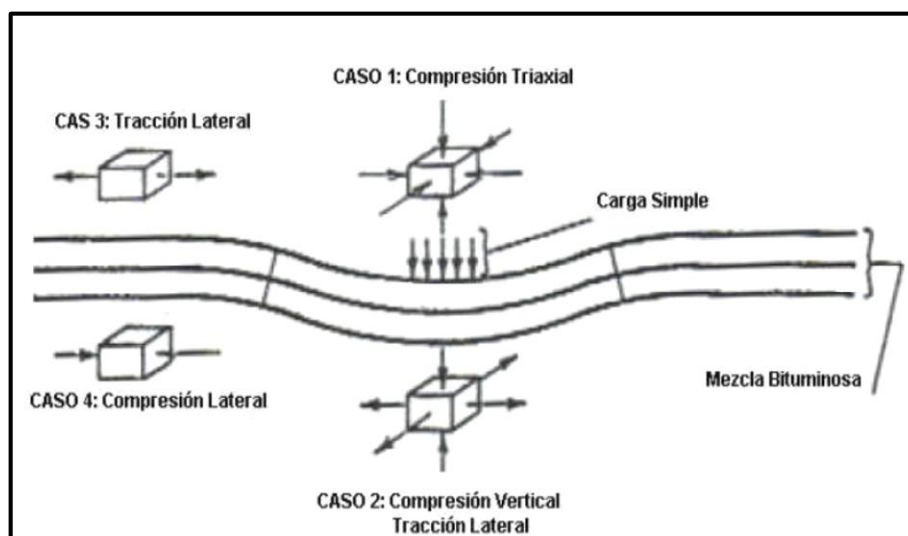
Estado tensional en un pavimento bajo carga simple.
